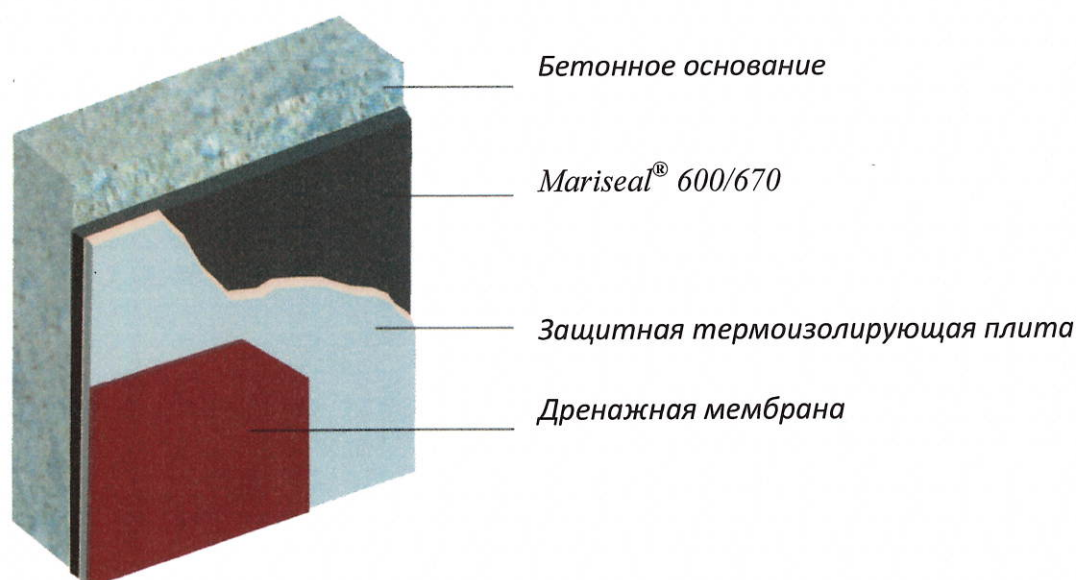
Устройство гидроизоляции на подпорных стенках и фундаментах (Раздел 10)
